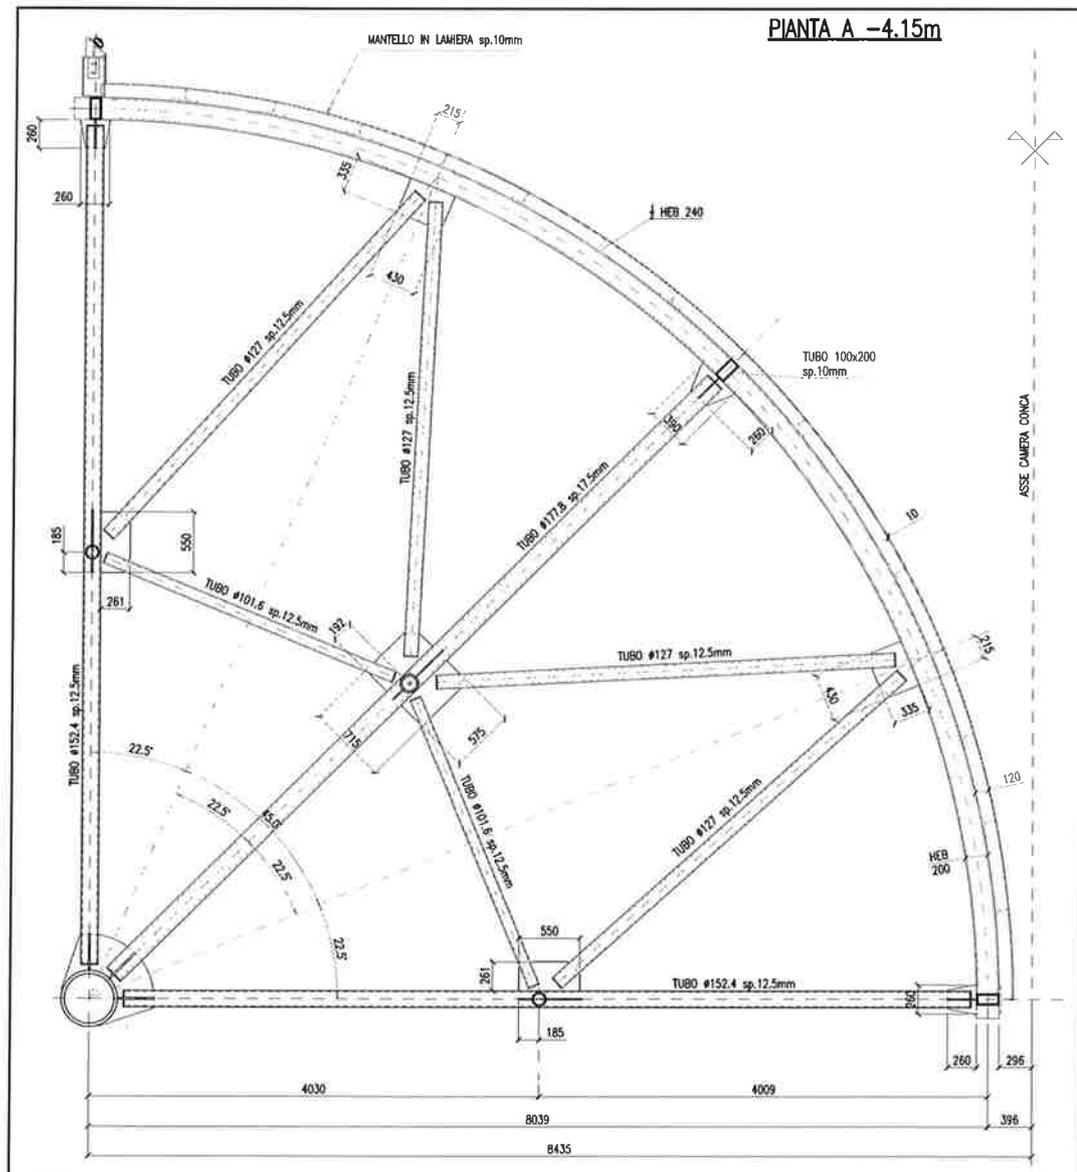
PIANTA PORTA A QUOTA -4.15
